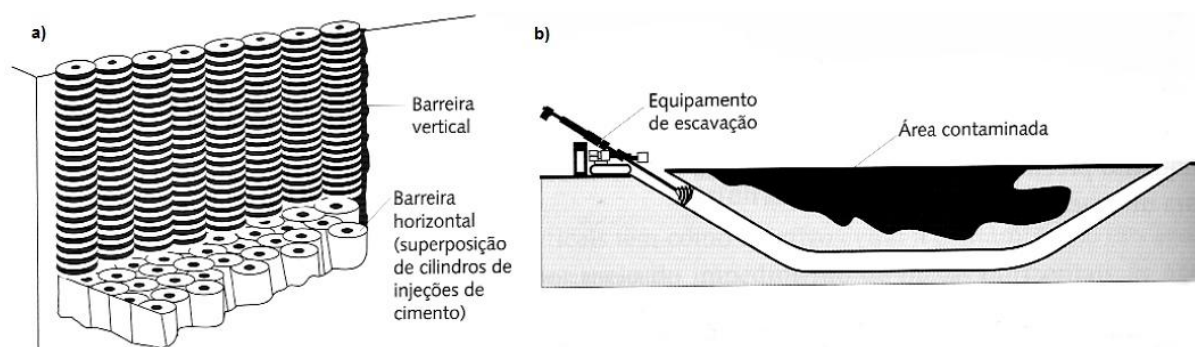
Configuração típica de barreiras horizontais para remediação: (a) barreira horizontal construída por injeções de cimento (*jet grouting*) ; (b) Barreira horizontal construída por perfuração direcionada a partir da superfície (Fonte: a) Grassi, 2005; b) adaptada de *Assessment of Waste Barrier Containment System*, 1997 - apud DYMINSKI, 2008)
